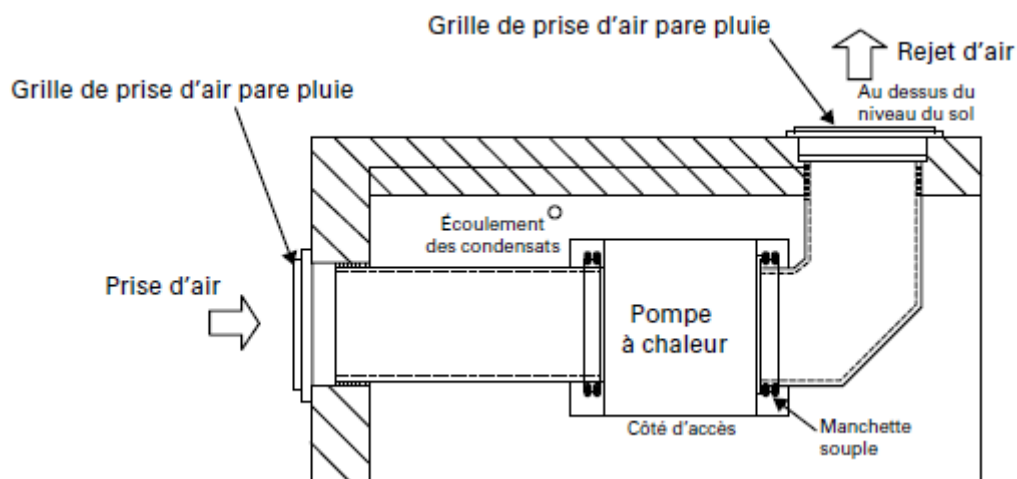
Exemple de disposition des grilles de prise d'air et de rejet d'air sur des façades différentes (vue de dessus)
